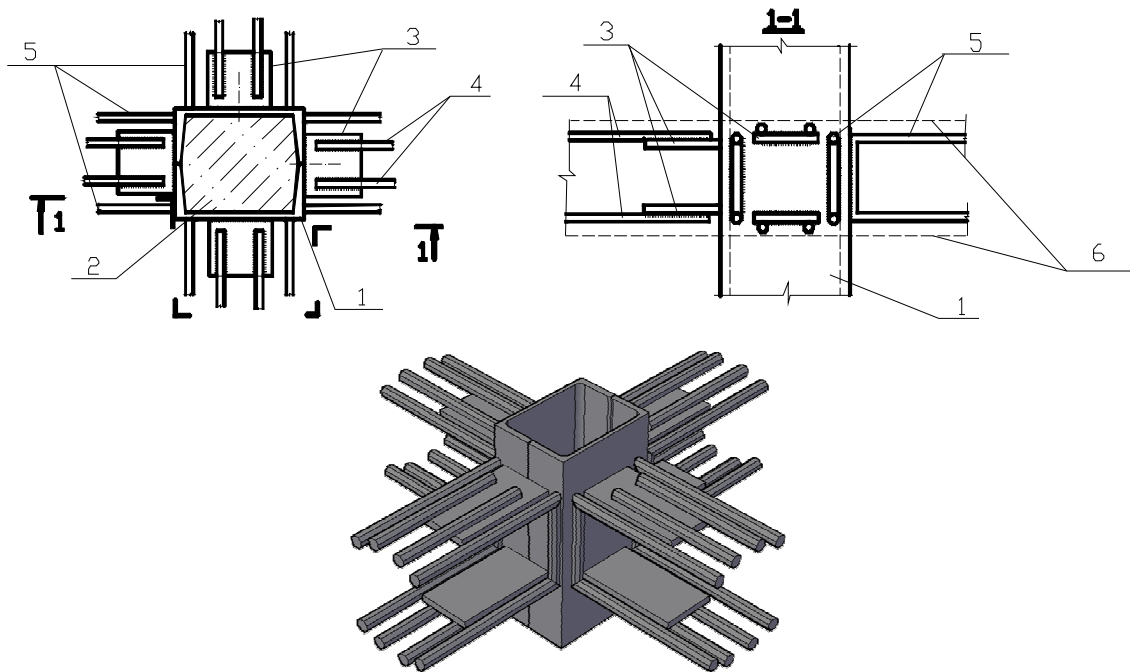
Безкапітельний вузол з'єднання монолітного безбалкового перекриття з колонами зі швелерів: 1 – металева оболонка з двох швелерів, зварених “у коробочку”; 2 – бетон; 3 – сталеві пластини; 4 – арматурні стрижні; 5 – відгини монолітної залізобетонної плити; 6 – контури монолітної залізобетонної плити перекриття
